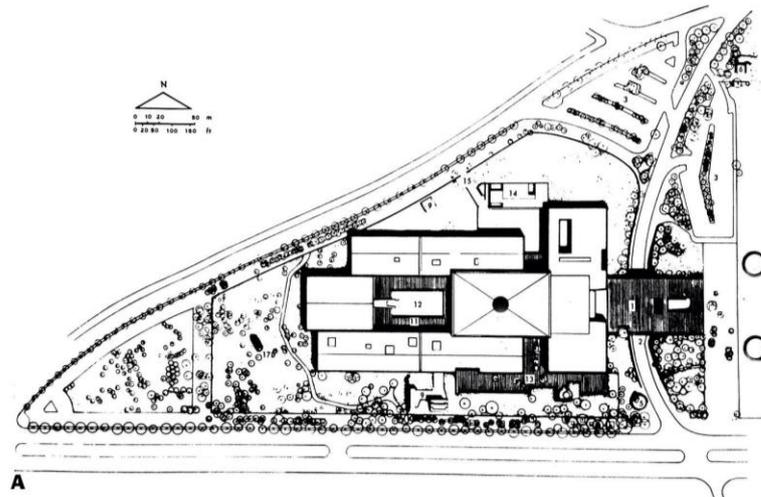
Planta de sitio. Fuente: Archdaily, 2014. Elaboración: Imagen de cortesía de la página web de MNA de México.
